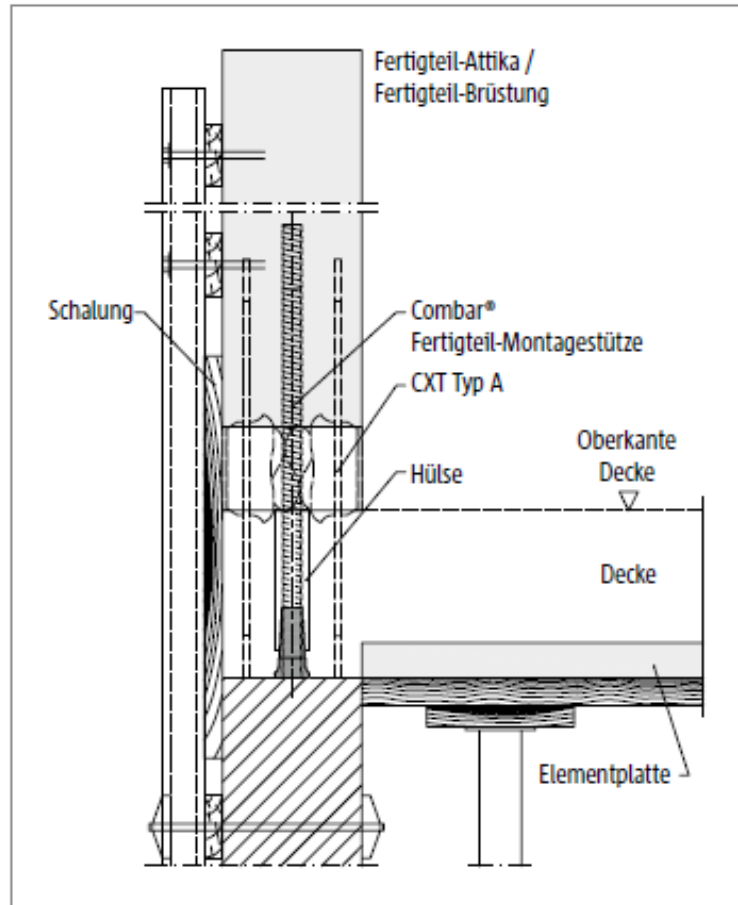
Schöck Combar® Fertigteil-Montagestütze: Einbau einer Fertigteilattika; Schnitt
